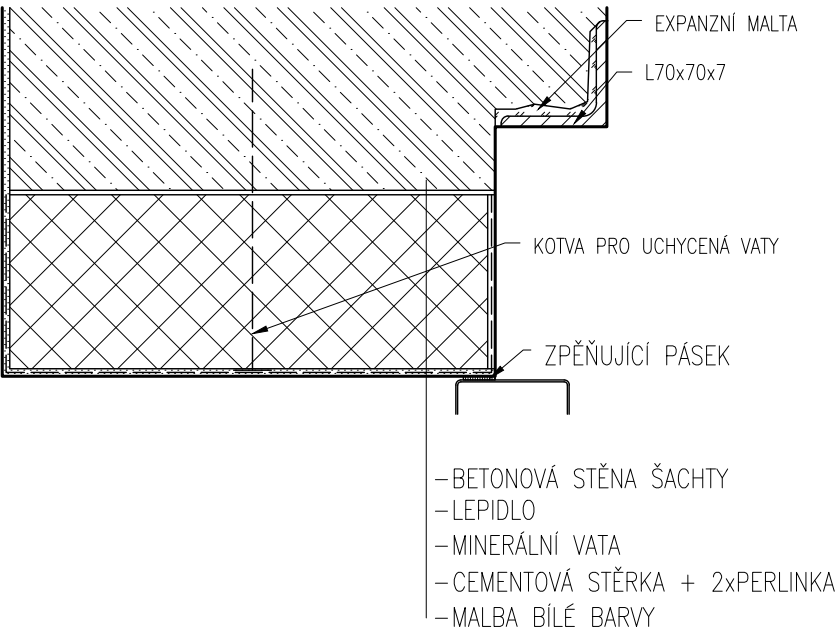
PRÁH ŠACHETNÍCH DVEŘÍ
